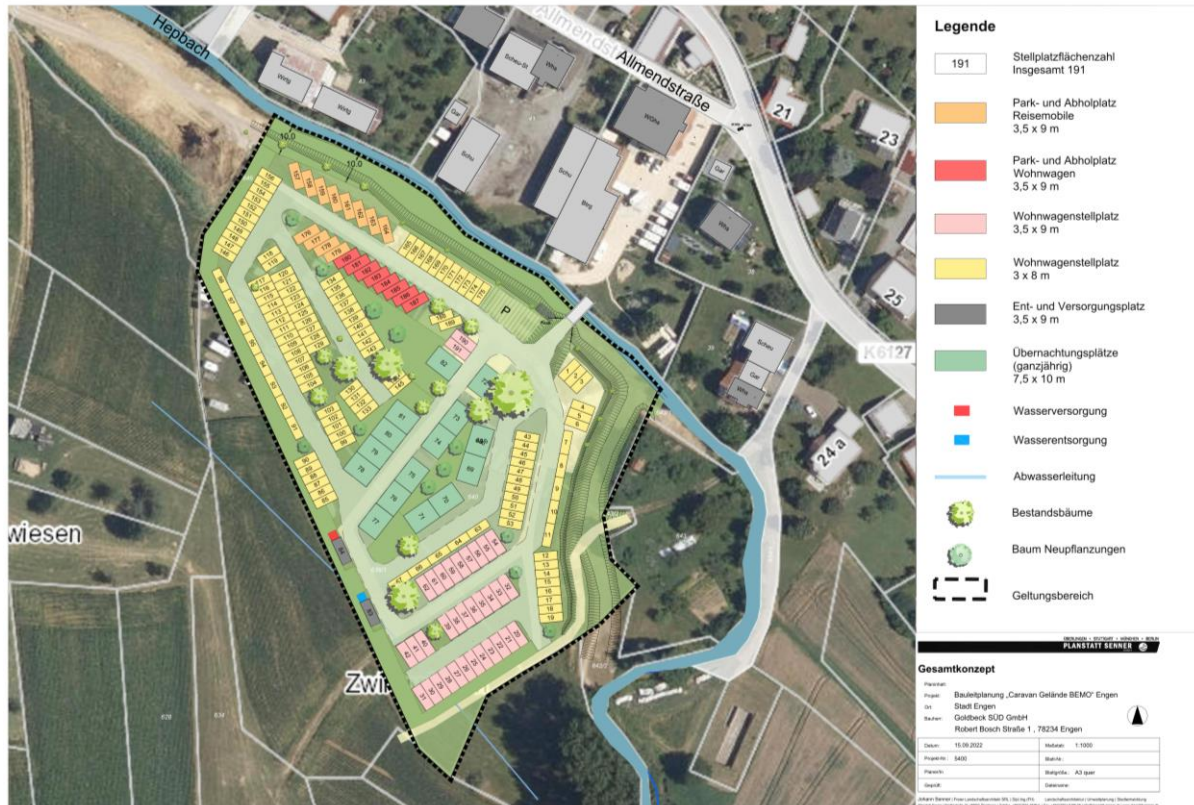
Vorhaben- und Erschließungsplan (Quelle: Planstatt Senner)
